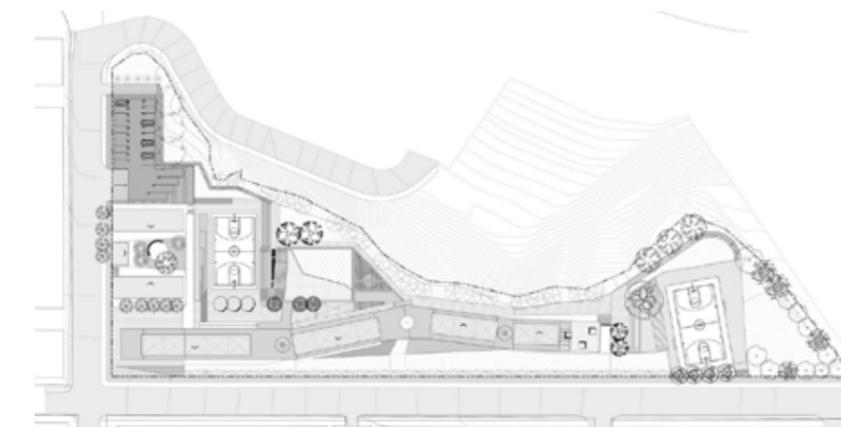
Planta de implantação. Fonte: Archdaily Brasil.
